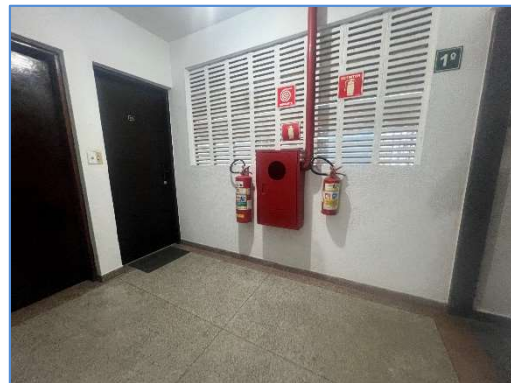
Vista do hall de circulação do prédio/entrada B do Bloco 3
